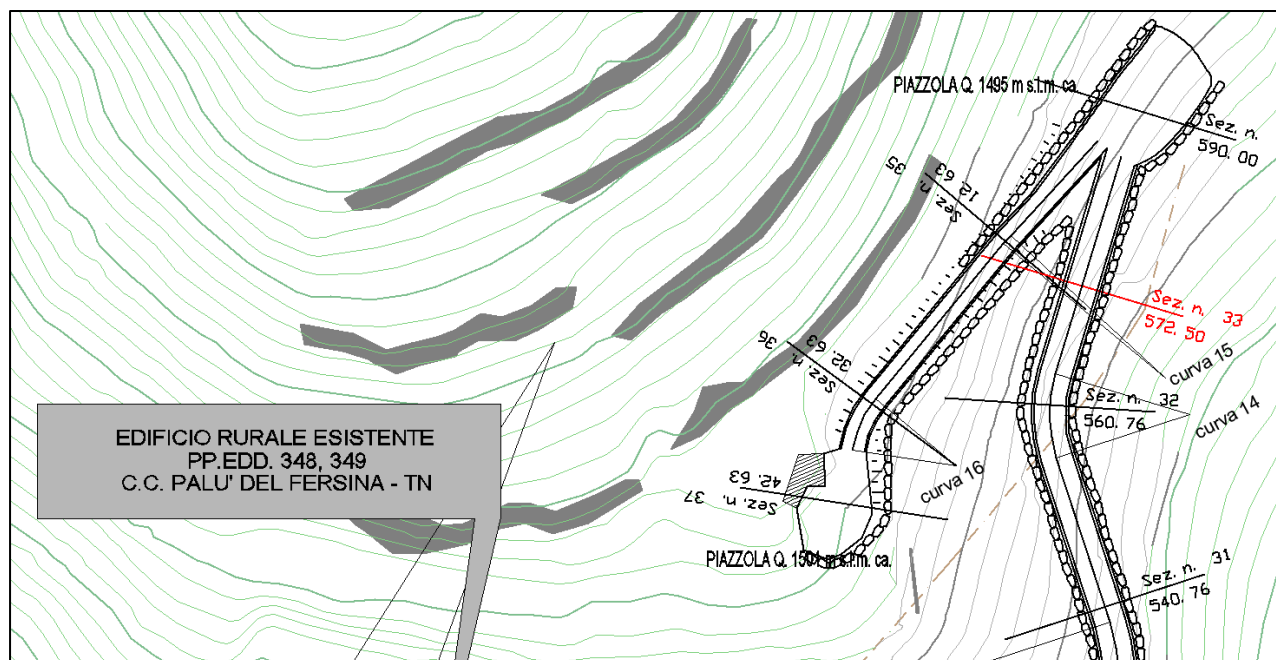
Loc. Ouberstoll - SEZ. 33 - UBICAZIONE TRACCIA SEZIONE DI CALCOLO GEOTECNICO
